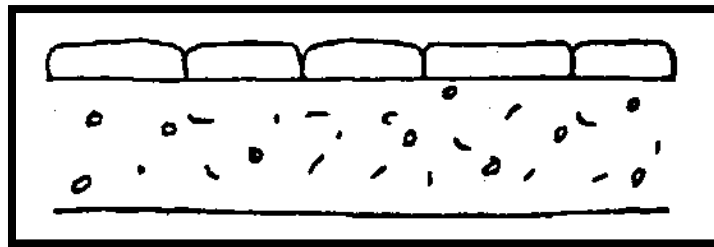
Sección de pavimento tipo propuesta por Huber Gautier, (*fuentes: Zorio, 1987*).
